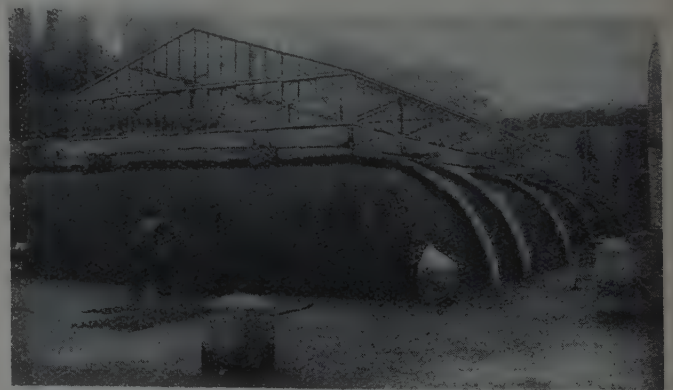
Application en 1926 de feuilles de bitume armé par soudure à la lampe sur une couverture en béton armé en forte pente.
